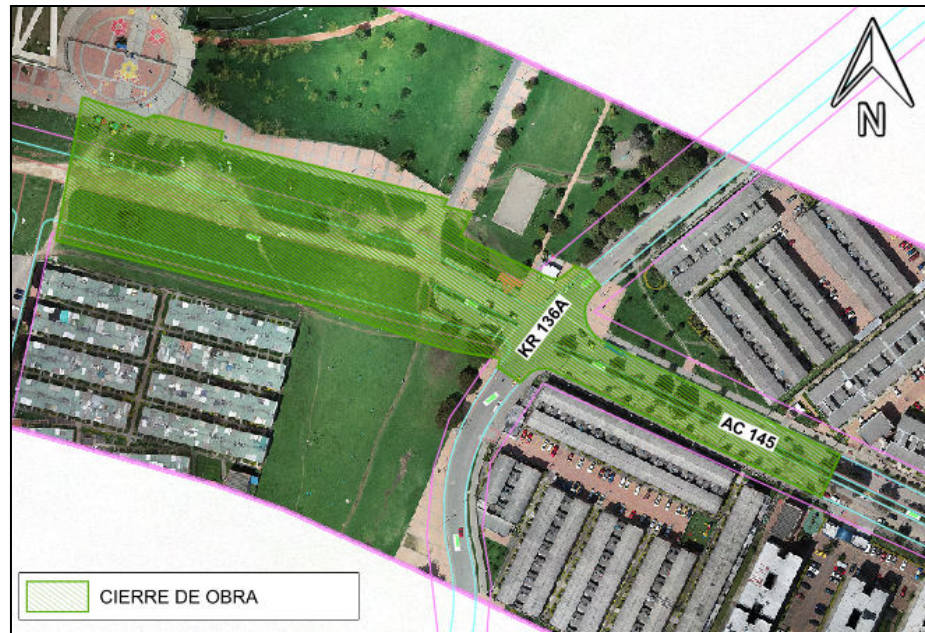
Cierres de obra para el Ingreso de Tuneladora - Etapa 2.
